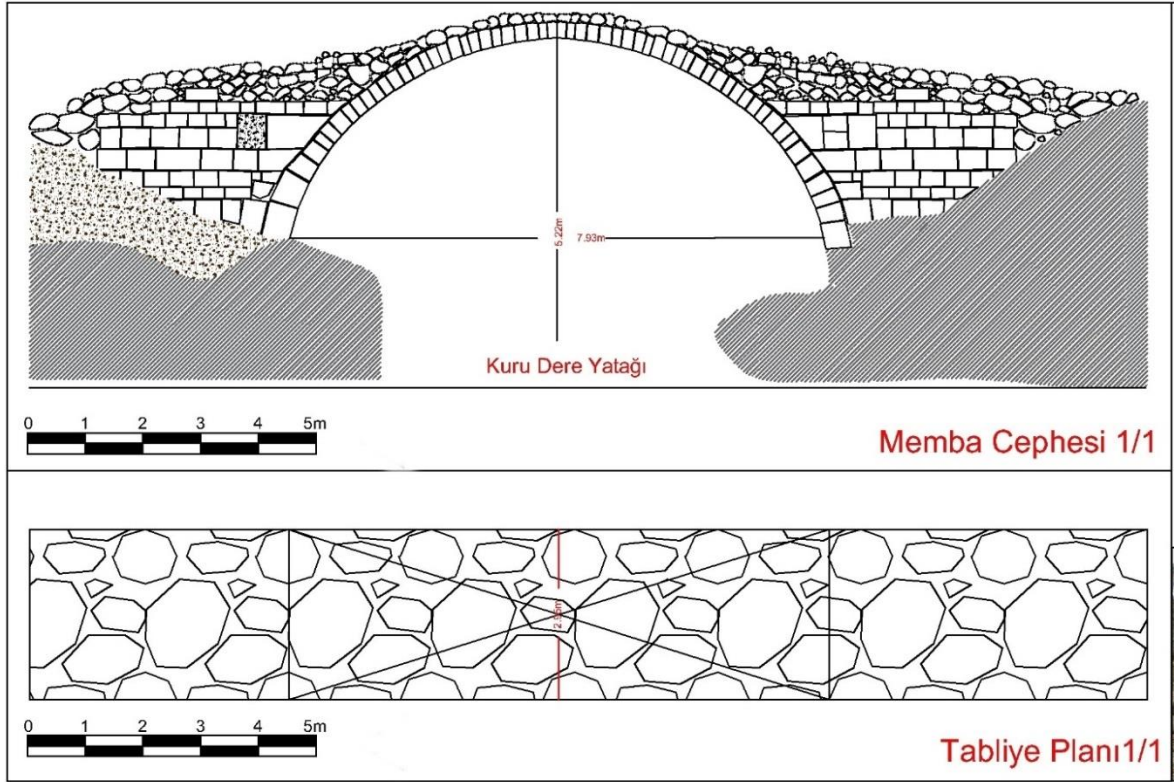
Sömek Köprüsü'nün memba cephesi ve plan çizimi
